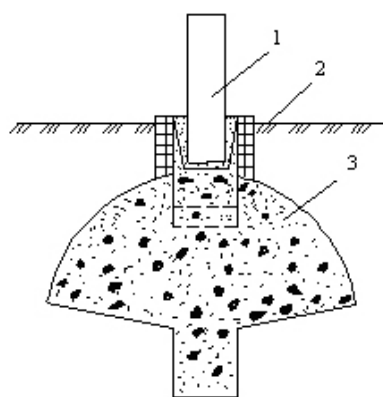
Буробетонный фундамент: 1 – колонна; 2 – стакан; 3 – уширенная часть фундамента
